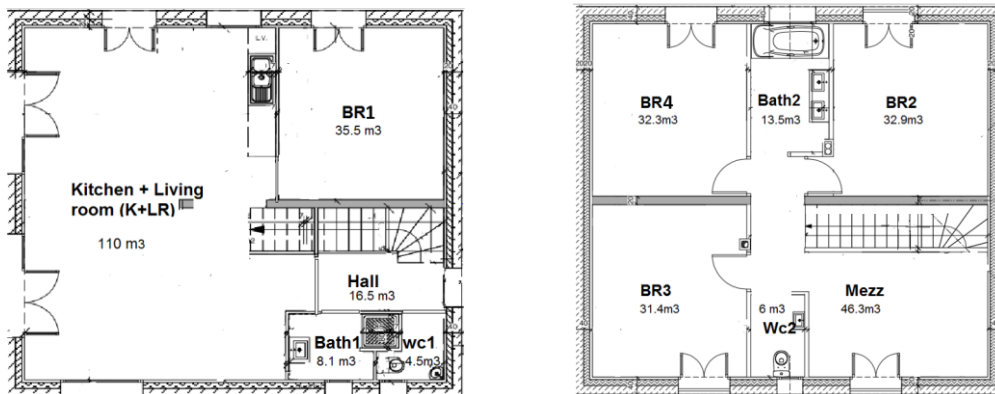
Plan de la maison individuelle, rez-de-chaussée (à gauche) et 1^{er} étage (à droite)
